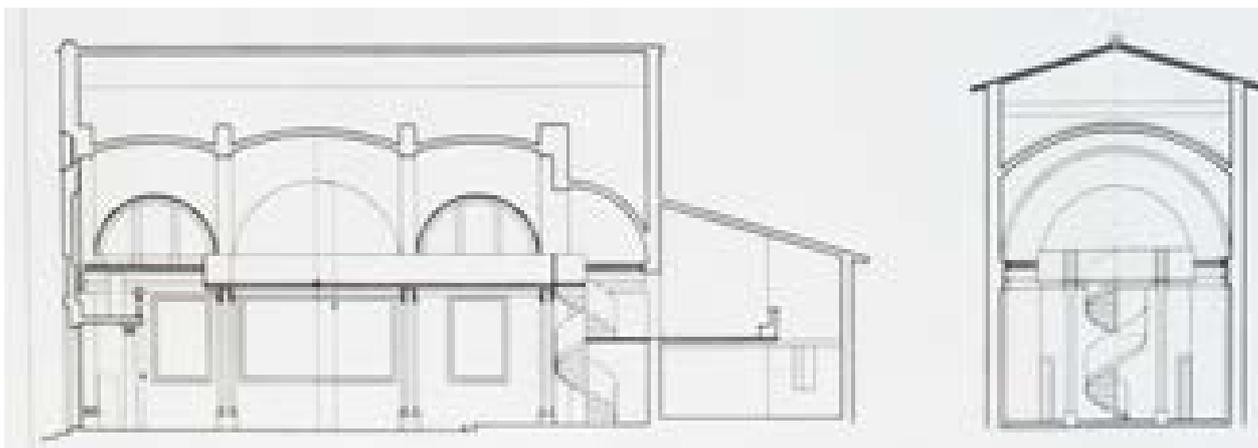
Sezioni – Stato di progetto – Bruno Sacchi – 10/06/2003 (AABS-94.213)
